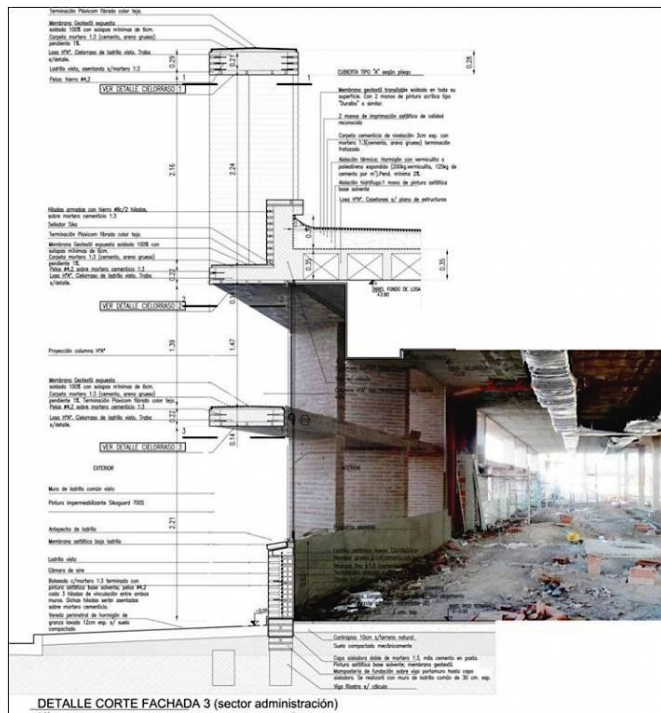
Corte por fachada del sector de administración. Se muestra en la parte superior la losa nervada, abajo los parasoles de concreto armado y ladrillo y en la parte inferior el doble muro. arqa.com
